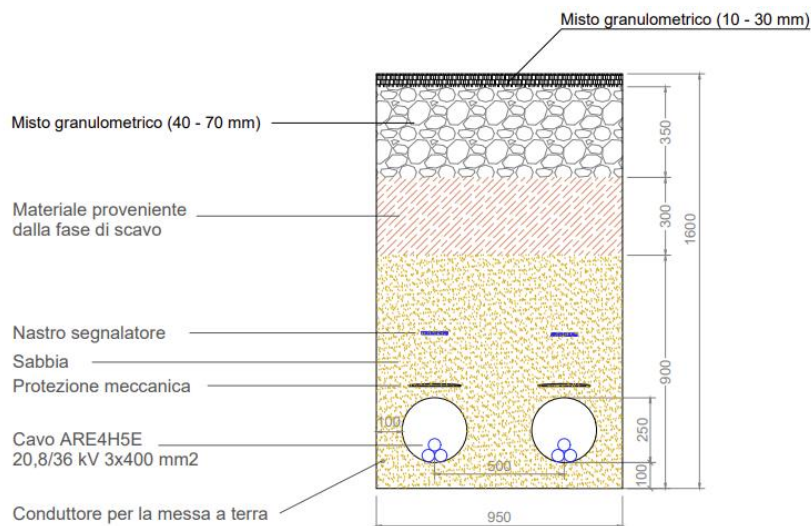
Sezione di scavo per cavidotto AT interrato (CC- CP)
